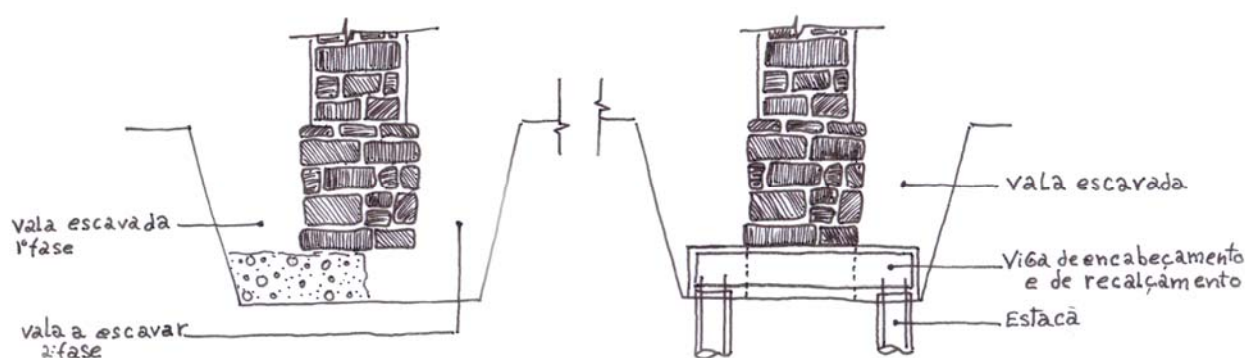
| Recalçamento de fundação com vigas de encabeçamento (se necessário com execução de estacas), com ou sem consolidação prévia da fundação existente (adaptado de [2, 13])
